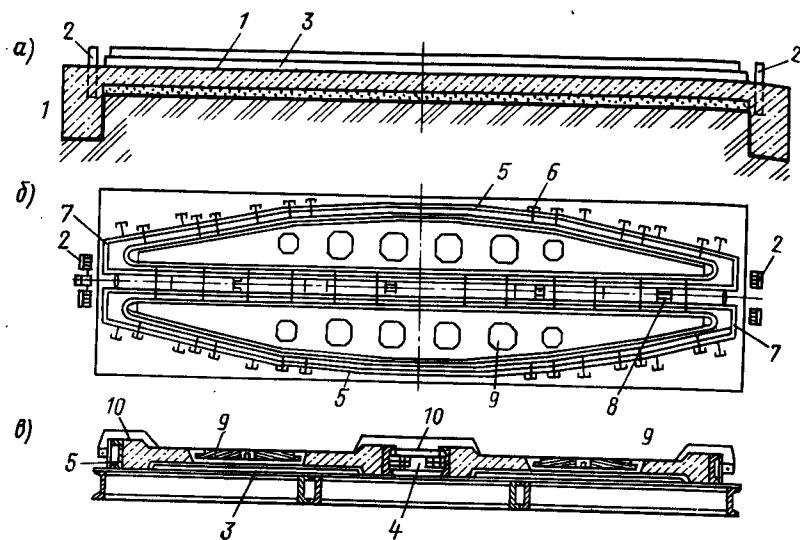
Стендовая силовая форма для изготовления железобетонных балок длиной 18 м:
